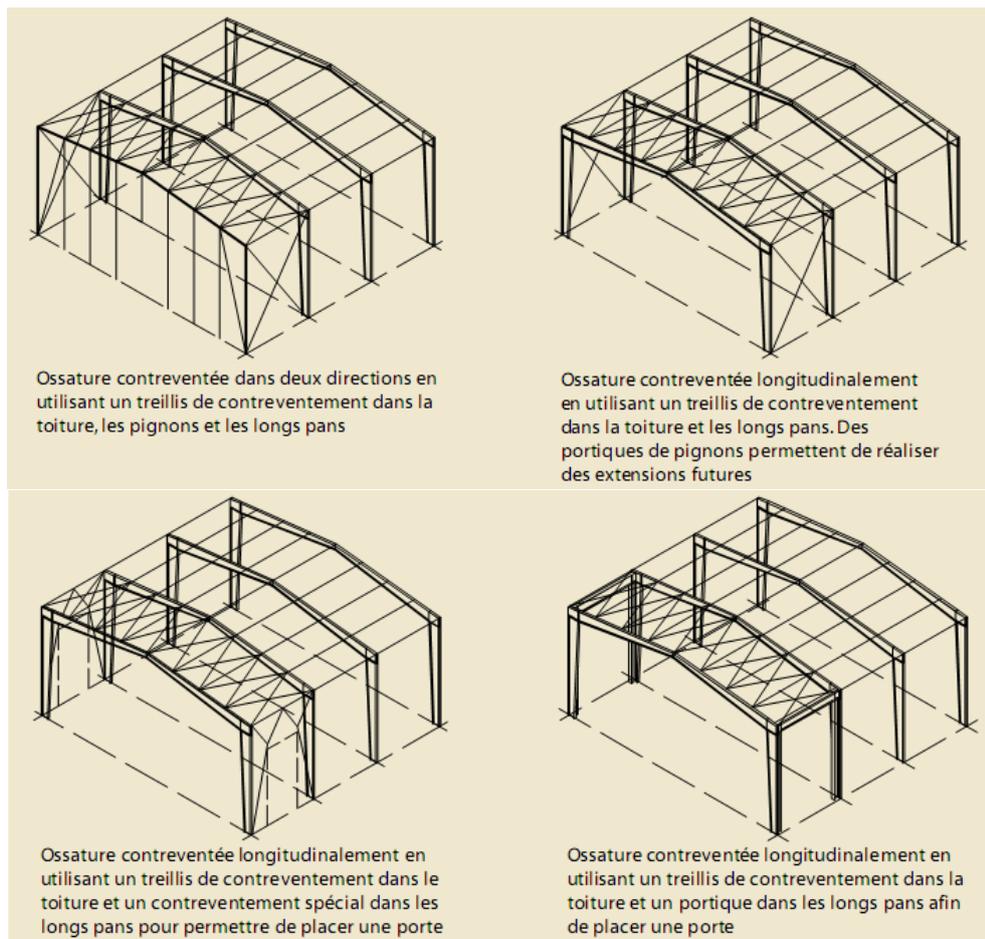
Exemples de contreventement hors du plan d'un portique
